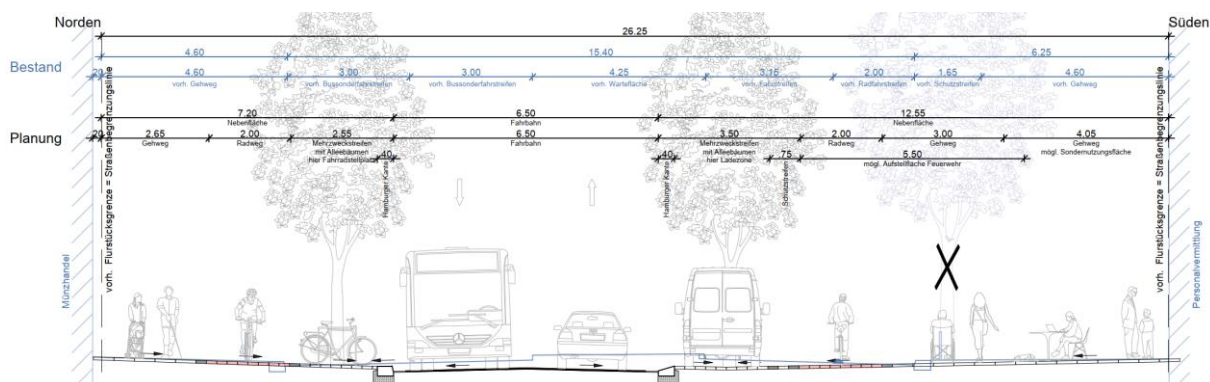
Querschnitt C-C der Ausführungsvariante (Steinstraße vor Haus Nr. 16/19)
